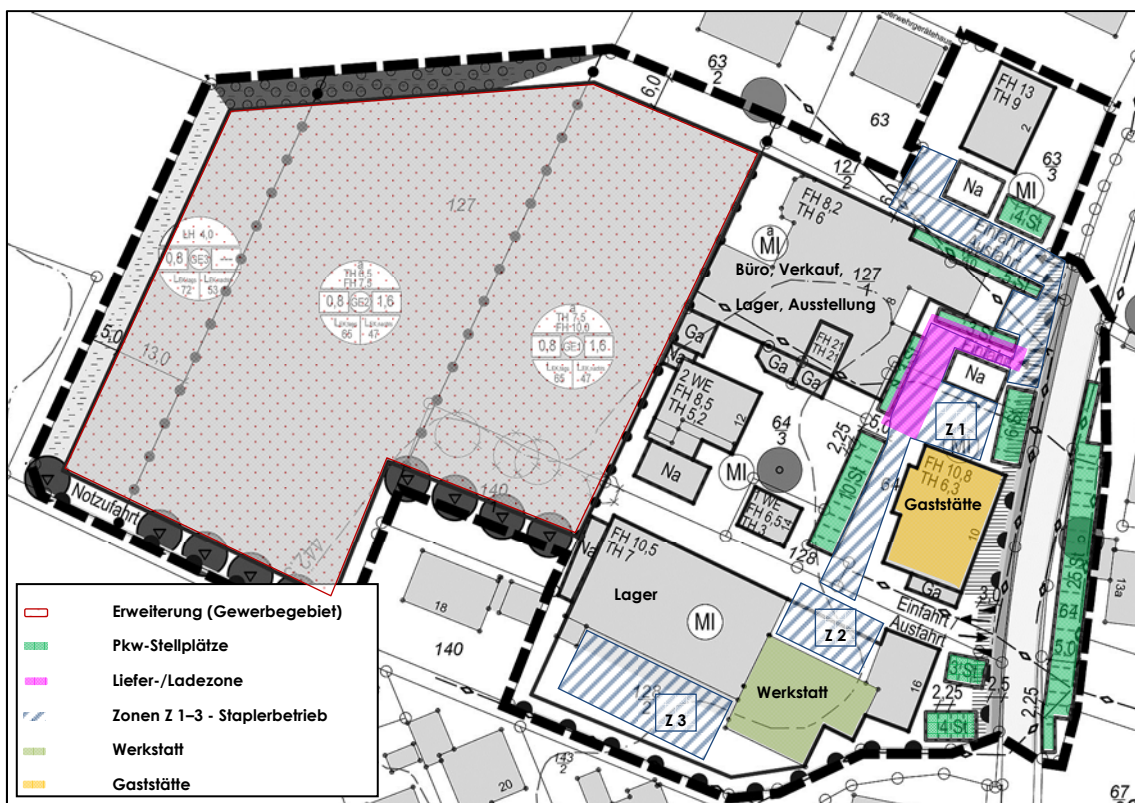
Lageplan mit Kennzeichnung der Erweiterungsfläche sowie der relevanten Betriebsteile im Mischgebiet
